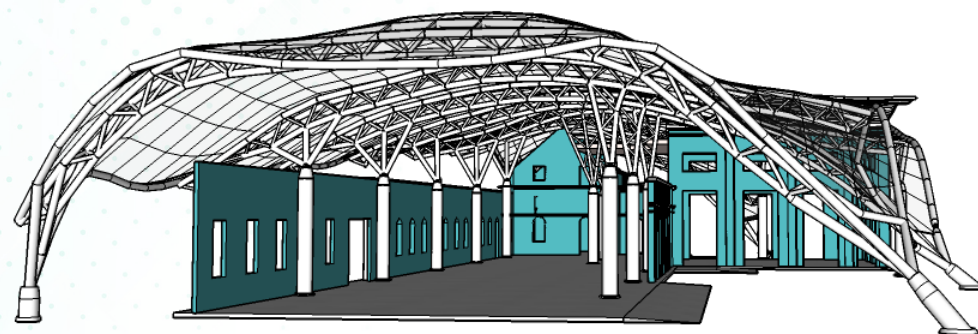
Ilustração da estrutura metálica da cobertura. Elaborado pelo autor, 2018
